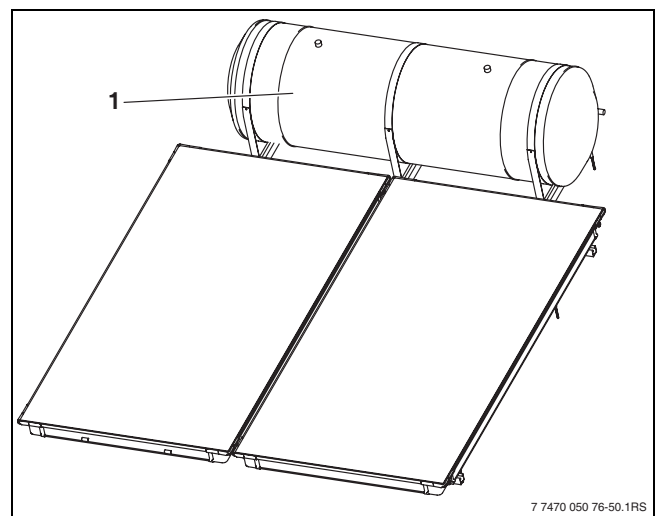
Vista da instalação para coberturas de telhados (aqui, sistema de 300 l)
